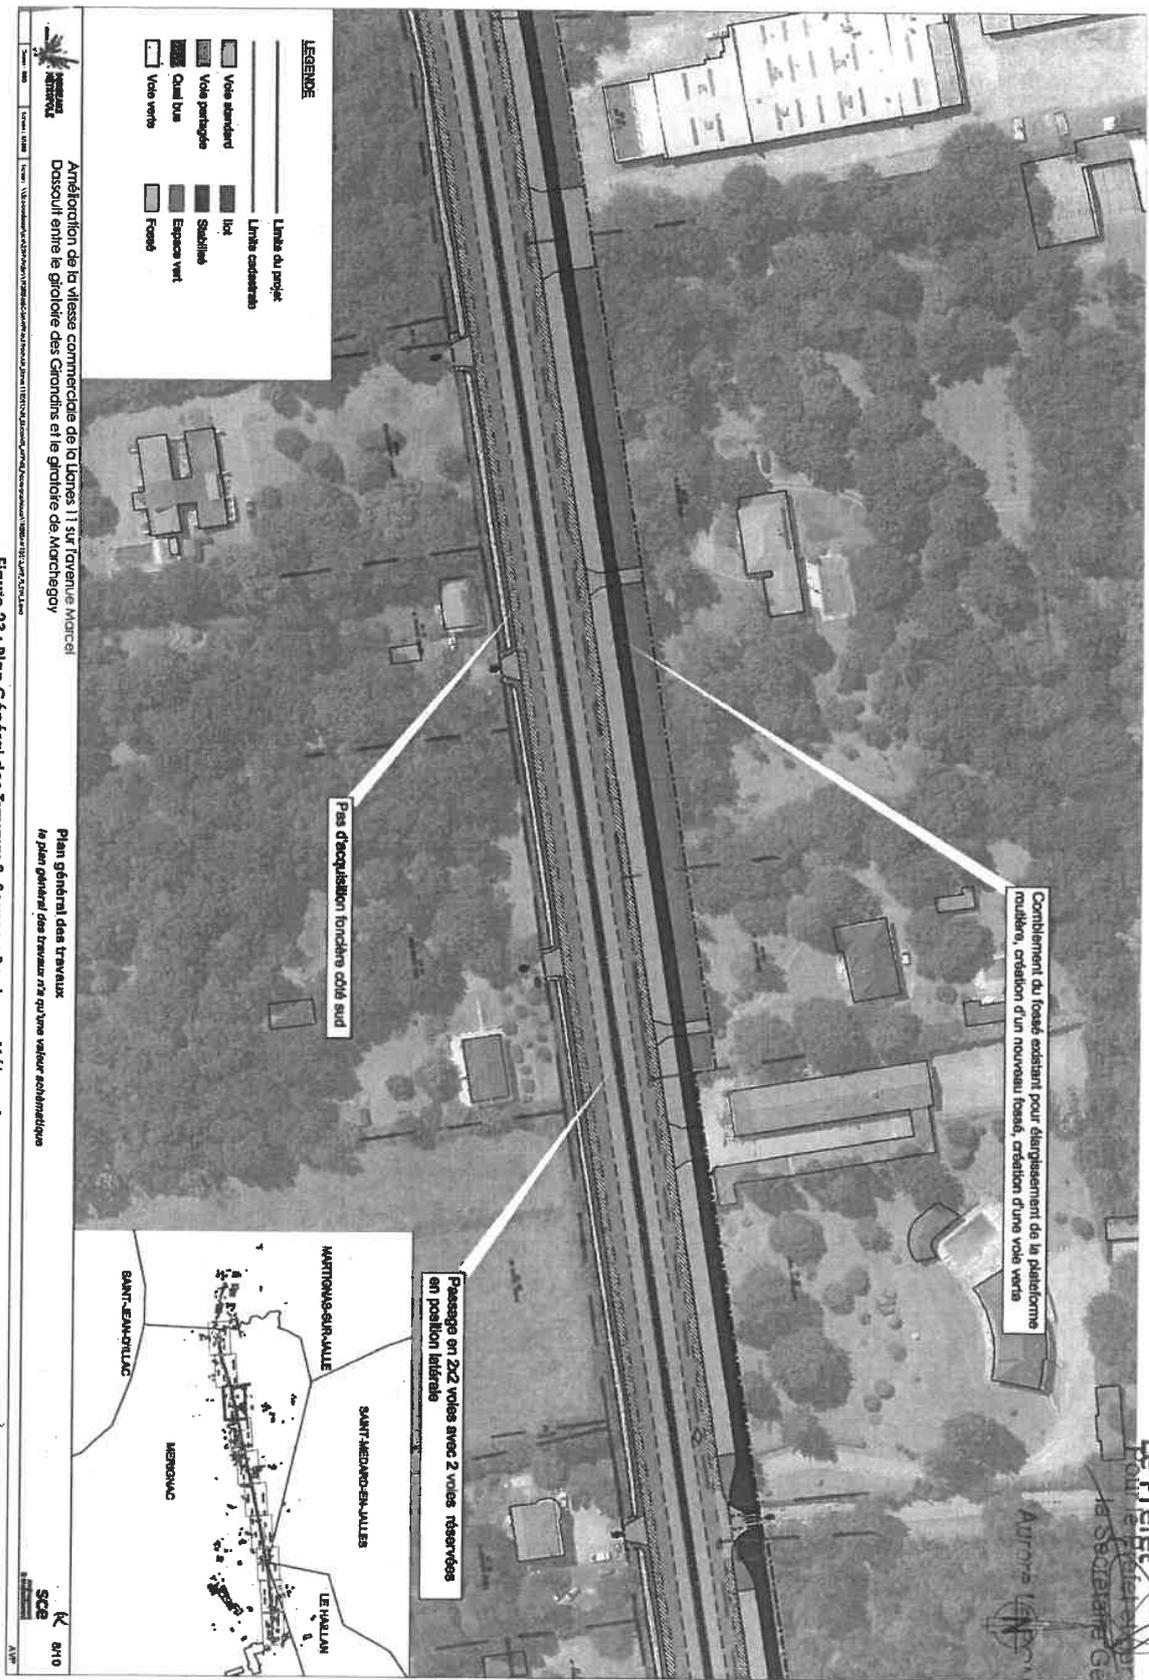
Plan Général des Travaux 3. Source : Bordeaux Métropole
